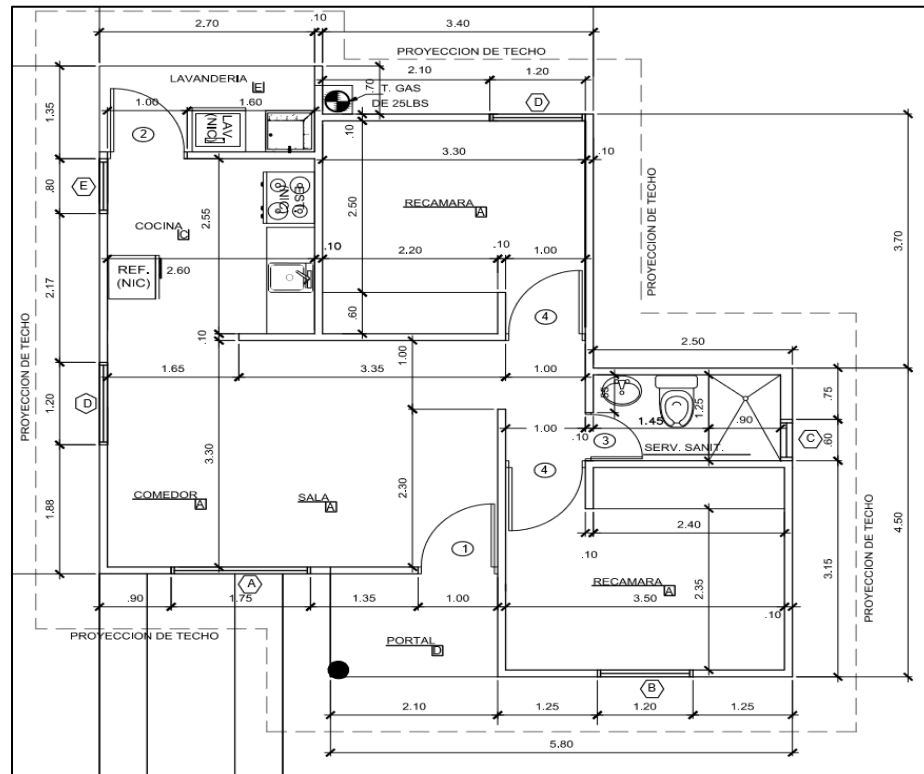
Planta arquitectónica de la casa. Fuente: Plano de anteproyecto.
